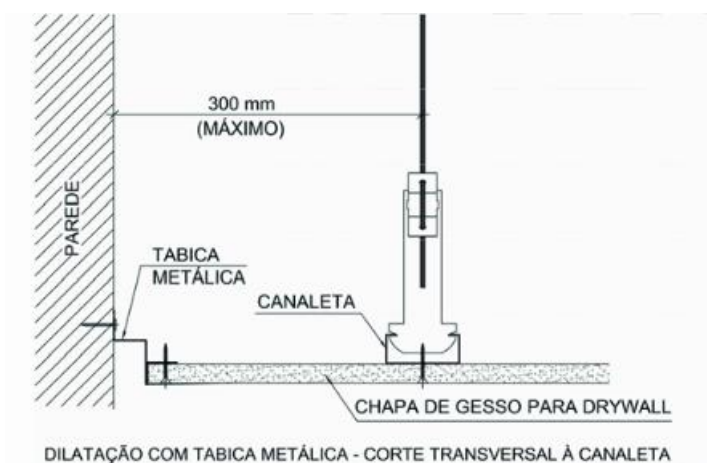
Detalhe Típico para forro em acartonado drywall estruturado
